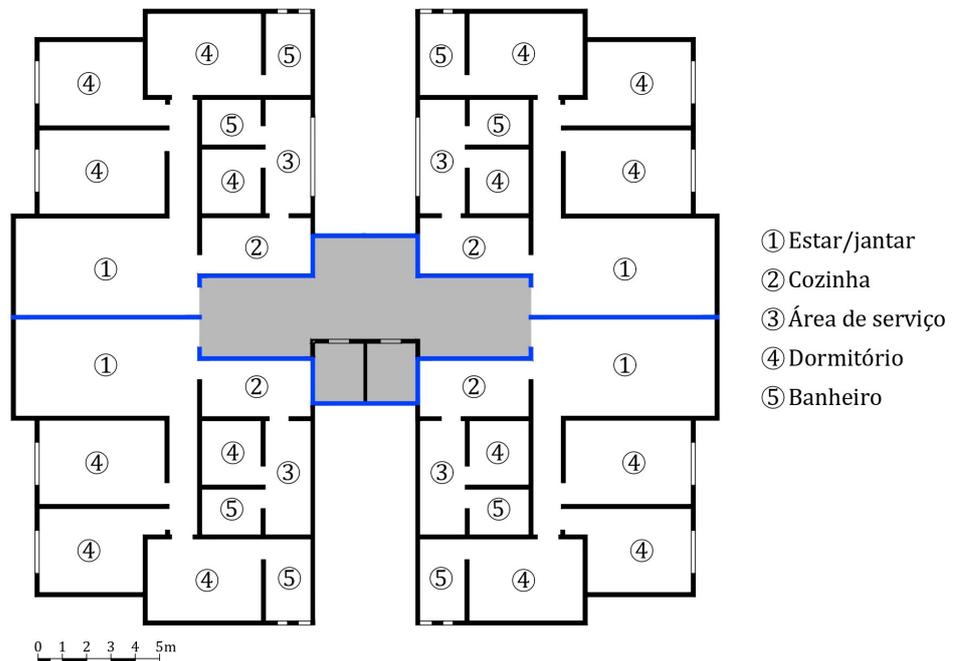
Planta do Objeto de estudo 5. Esquema sem escala.
